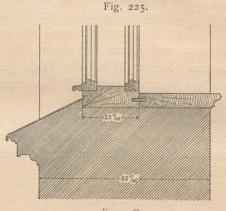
zeigt das Schema einer Fenster-Construction für Massivbauten.
